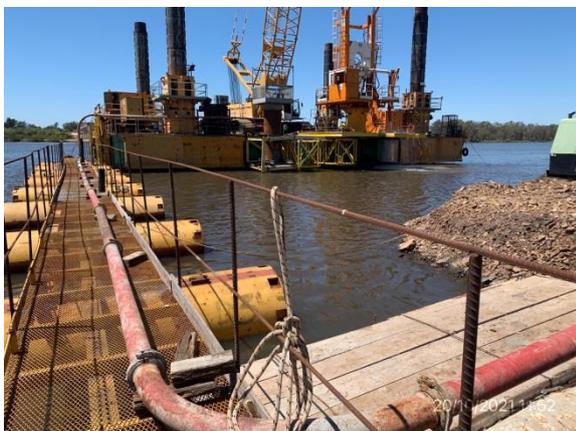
P01, Puente en obra. Pontón para pilotera y plataforma flotante de acceso.
